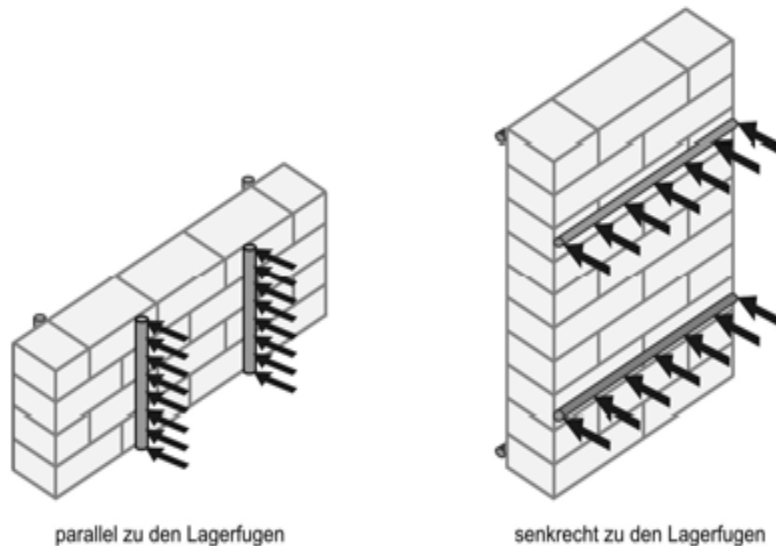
Beanspruchung auf Biegezug (parallel zu den Lagerfugen und senkrecht zu den Lagerfugen).
